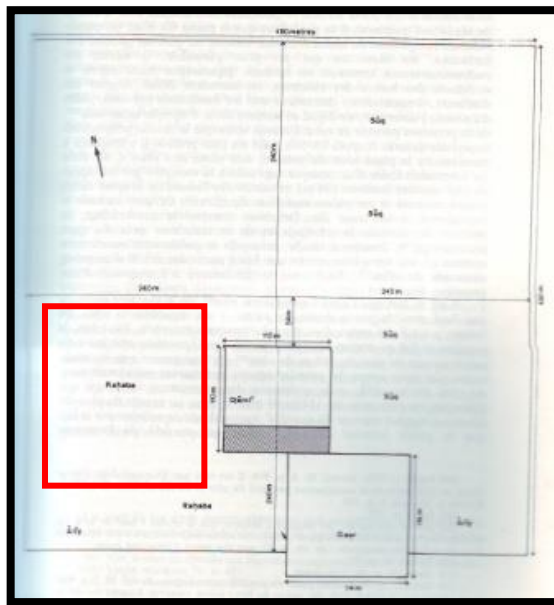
1er plan du sahn⁽⁶⁹⁾.
